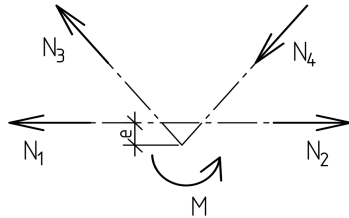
Расцентровка осей элементов фермы в узле верхнего пояса
